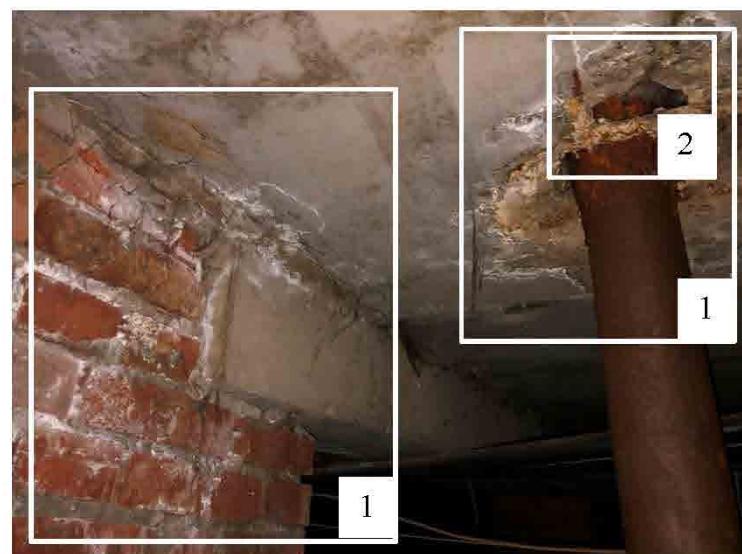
Фрагмент вида чердачного помещения. Дефекты: 1 – высолы, подтеки; 2 – разрушение бетона, оголение арматуры.
